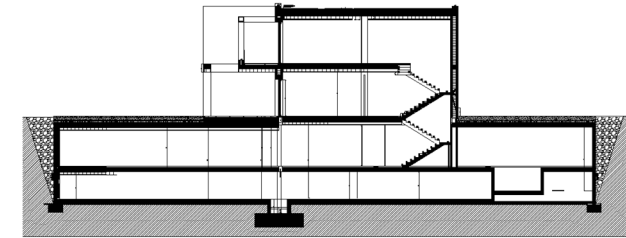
Sección vivienda objeto. Fuente: Elaboración Propia
